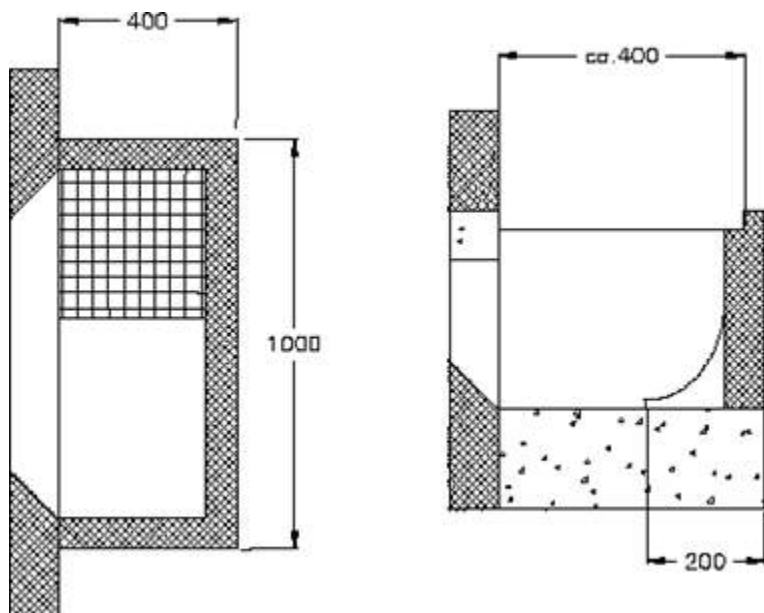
Exemple : Dimensions des puits de lumière standard
